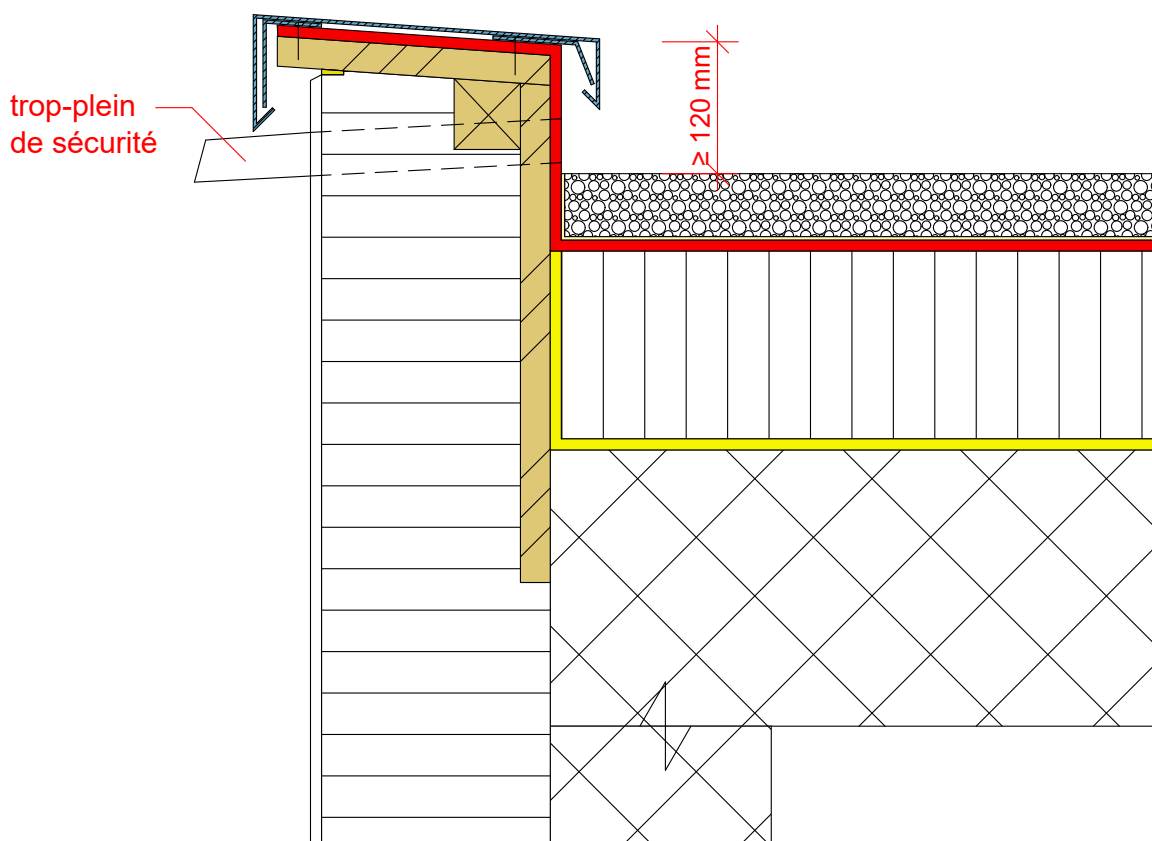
Constructions de bord du toit non résistantes aux débordements (exemple 1 Solution pour constructions neuves)
